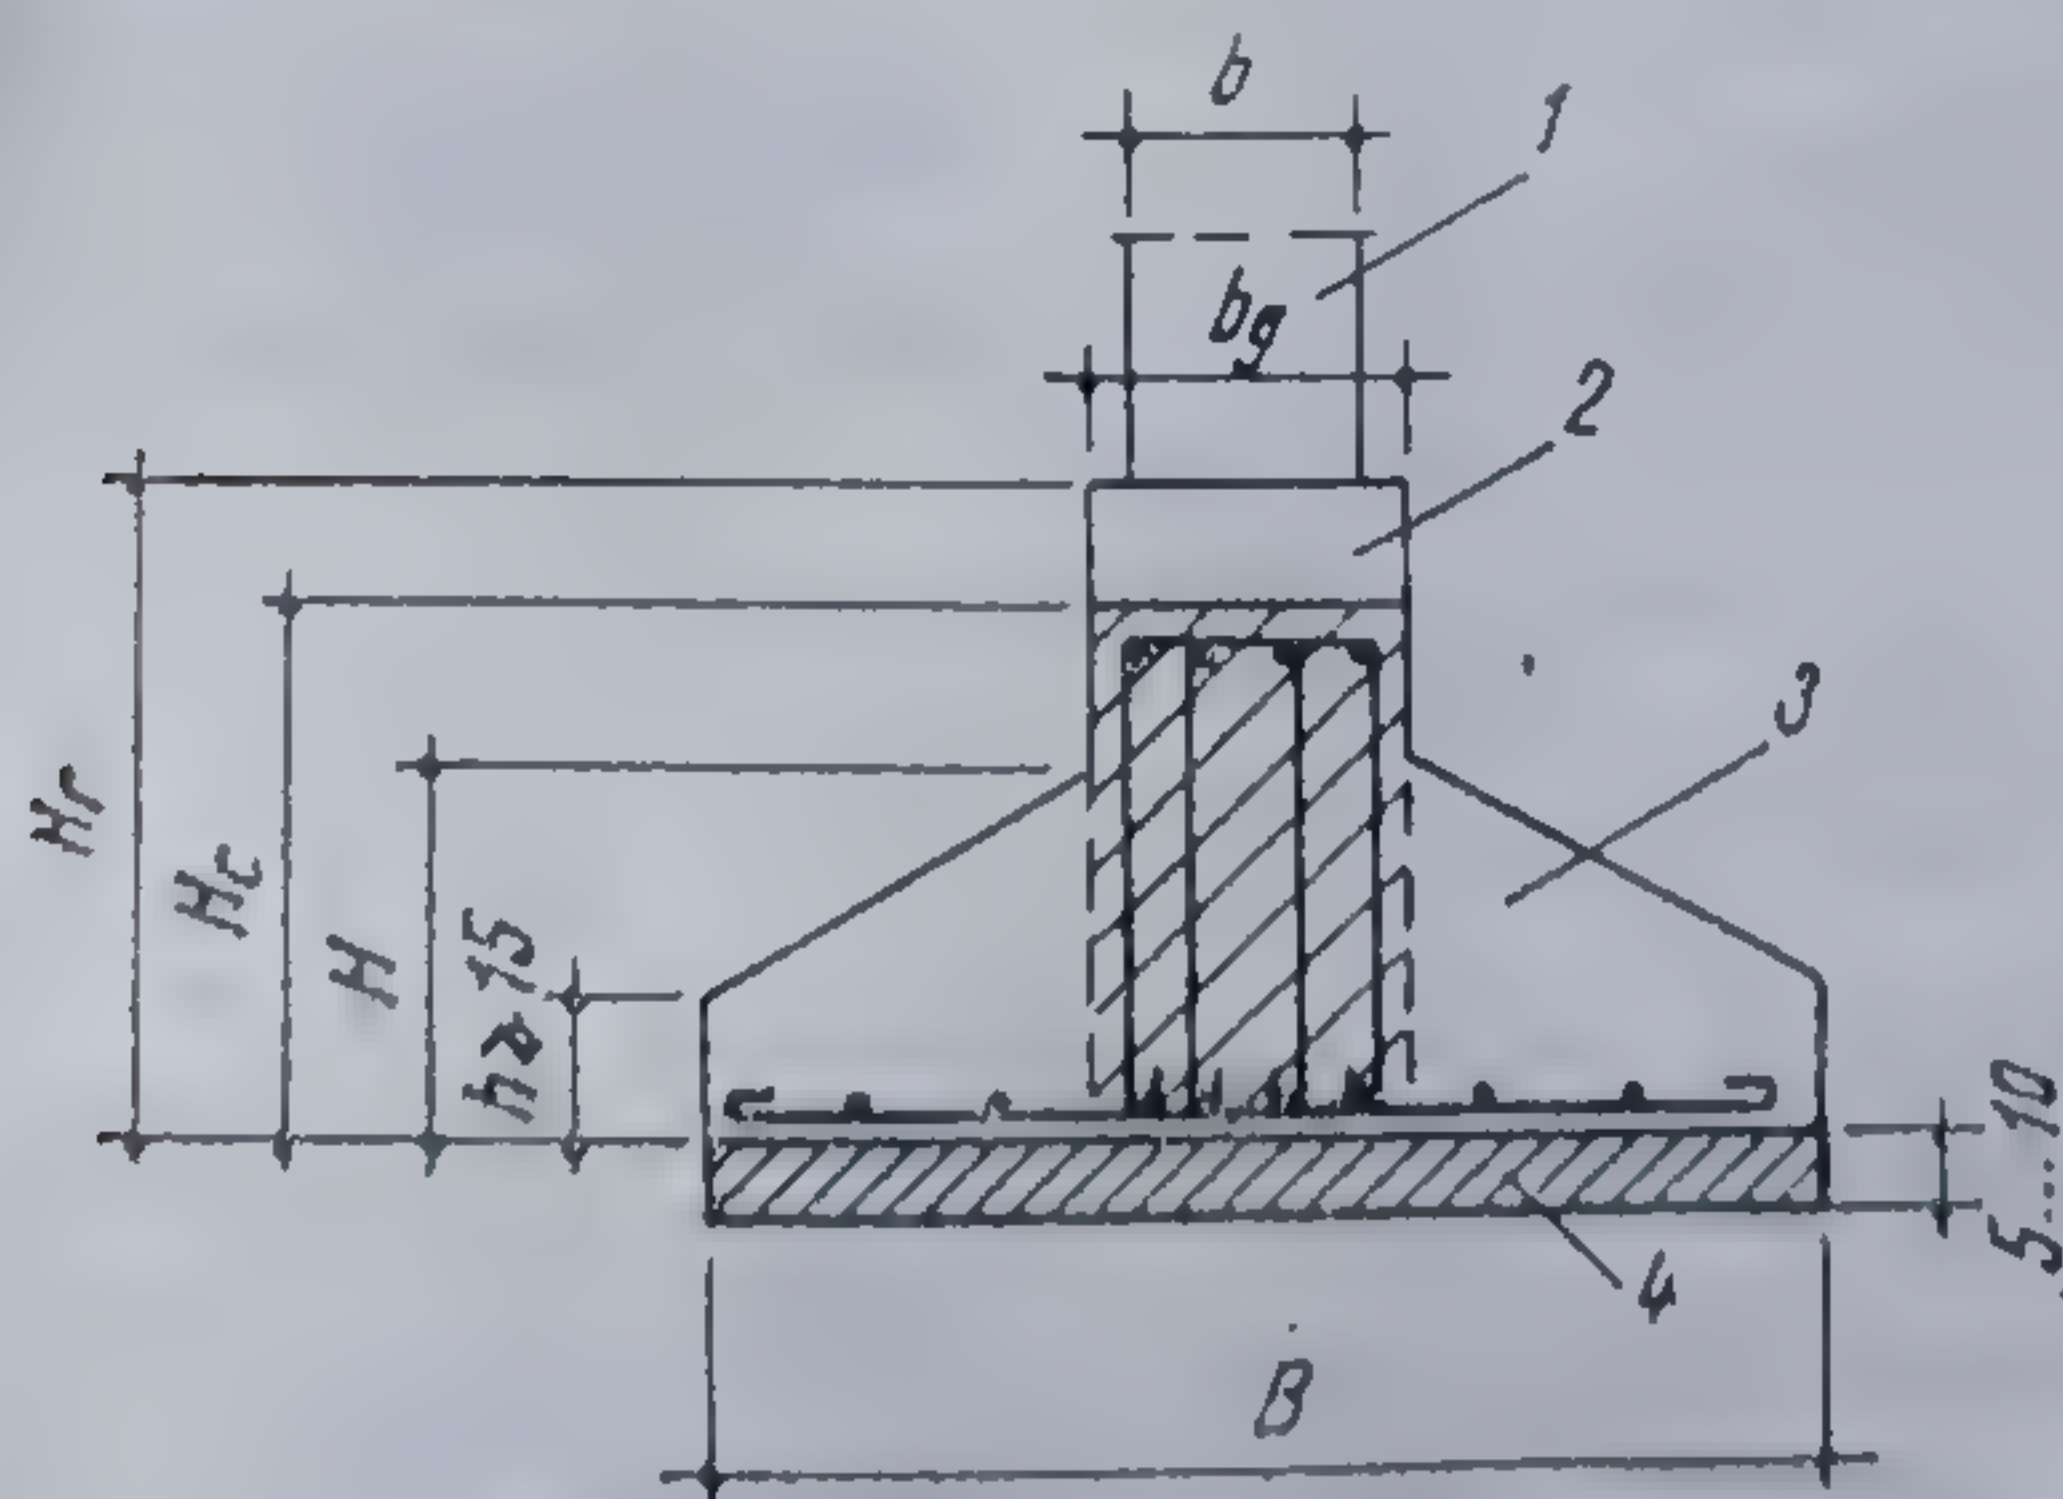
Secțiune printr-o fundație continuă din beton armat cu vute în dreptul stîlpilor :
